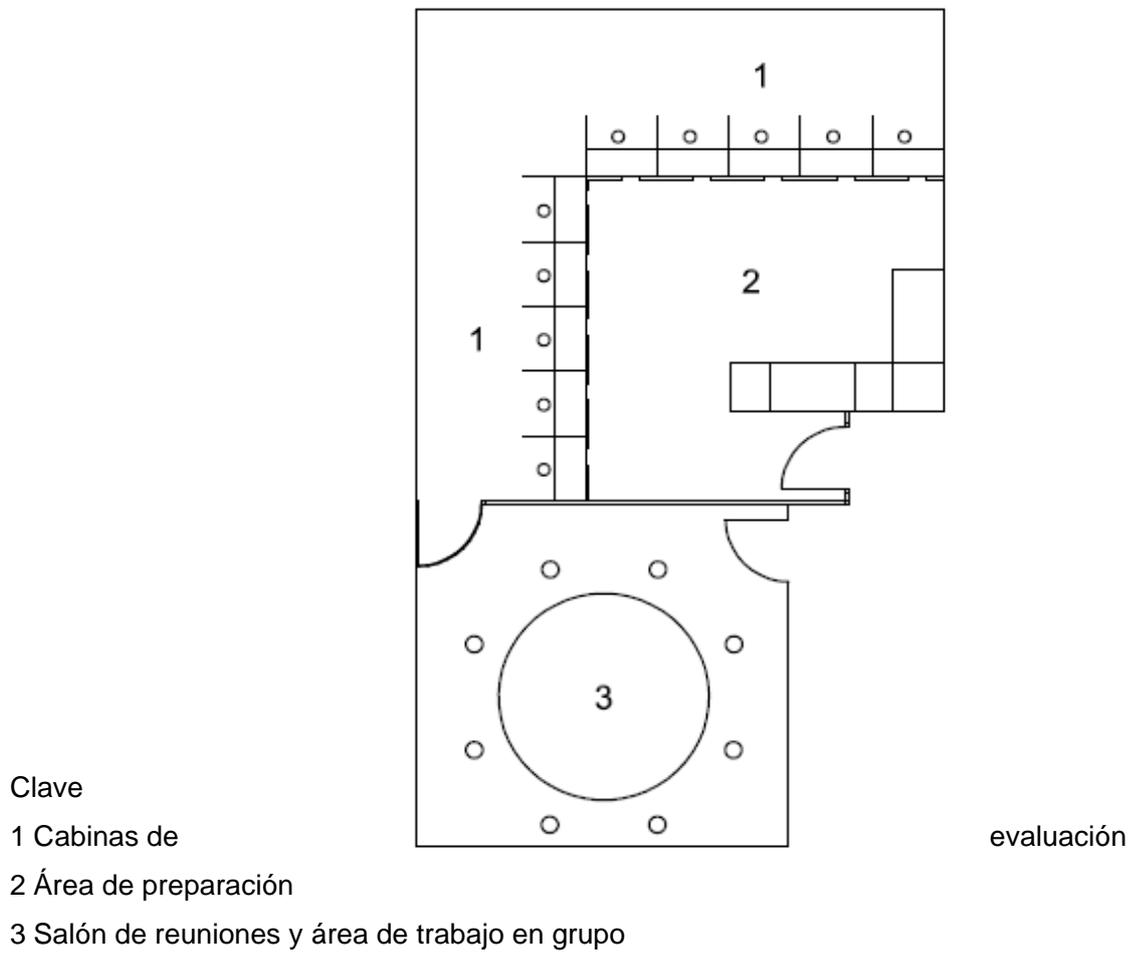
Segundo ejemplo de una vista en planta para un local de evaluación
